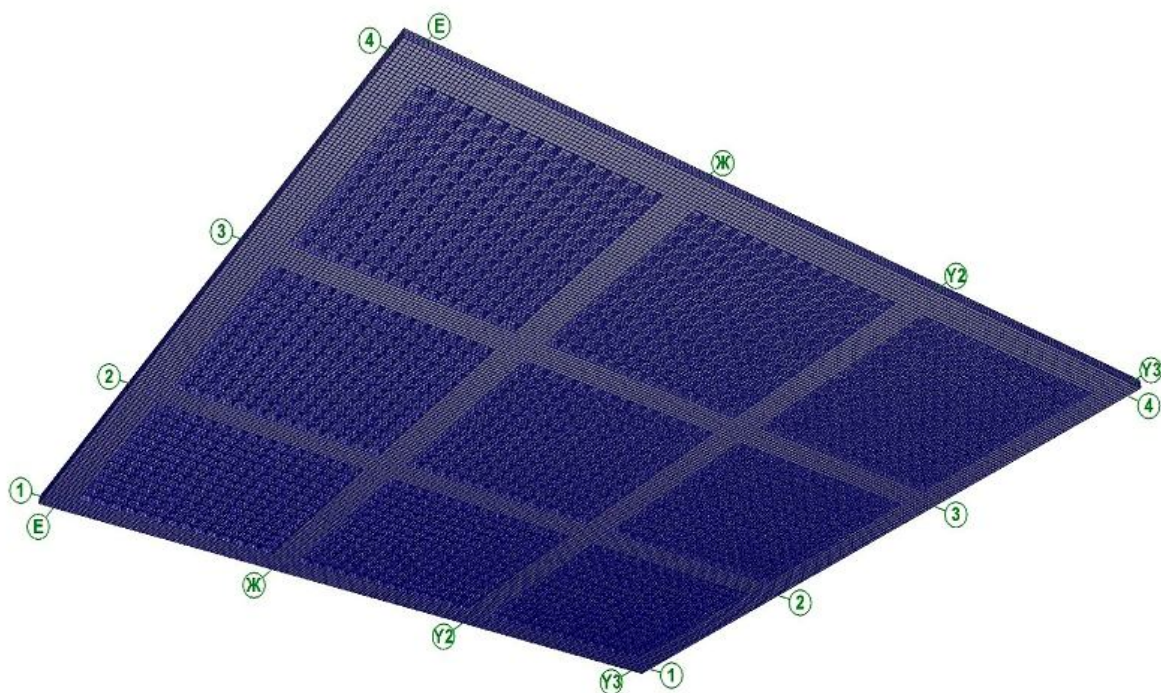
Сплошные монолитные балки по осям колонн, для напрягаемой арматуры в одной плоскости с перекрытием. Вид на перекрытие снизу.
